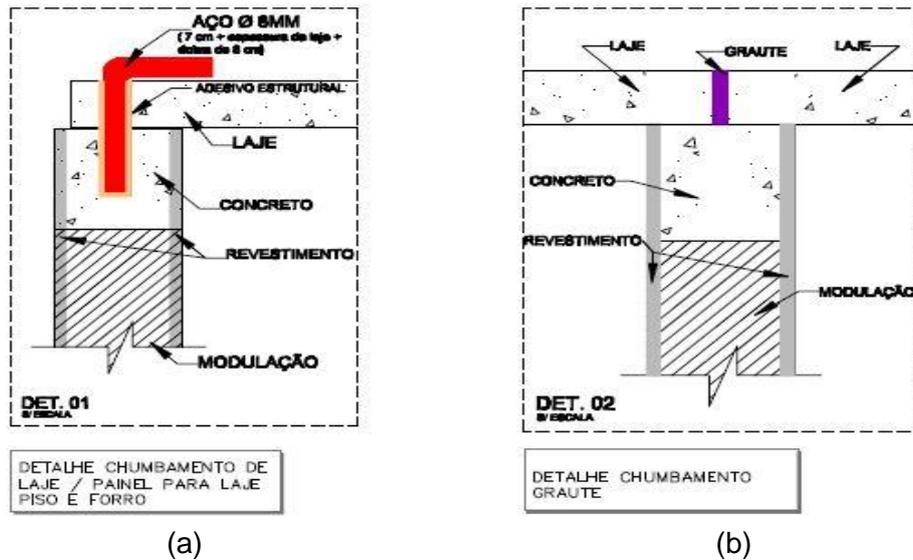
Detalhe da fixação da laje na parede (a) Fixação da laje na parte superior do painel com a utilização de chumbadores de aço de Ø 8,0 mm dobrado em L; (b) A união das lajes sobre parede deve ser executada com graute em toda sua extensão
